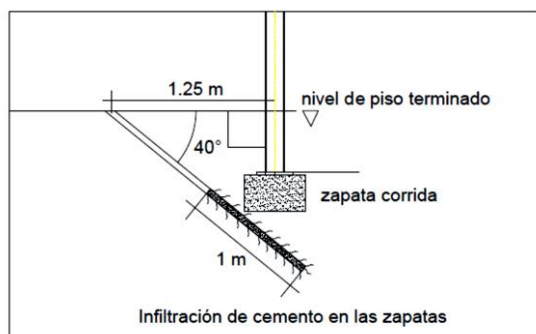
Esquema Para Infiltración de Cemento Debajo de la Zapata
